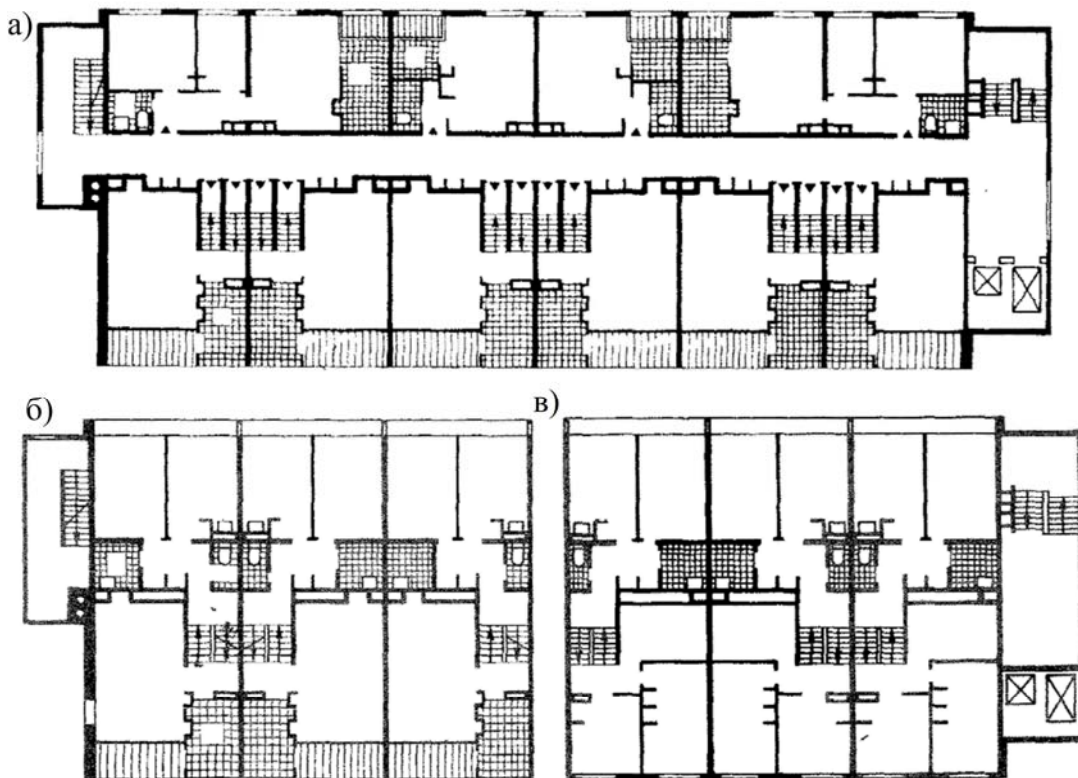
Коридорний житловий будинок з перепадом рівнів в половину поверху: а) план коридорного поверху; б) план поверху над коридором; в) план поверху під коридором.
